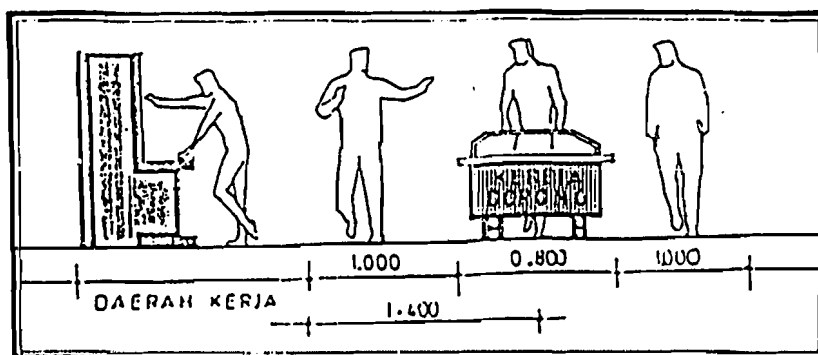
Kebutuhan ruang gerak berjalan membawa barang
